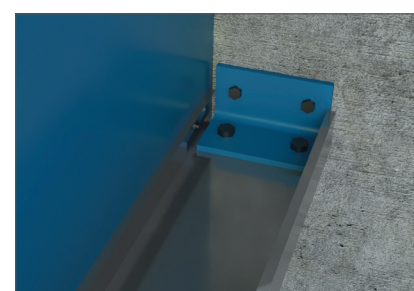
Provedení světlíkových výměn u betonových skeletů
